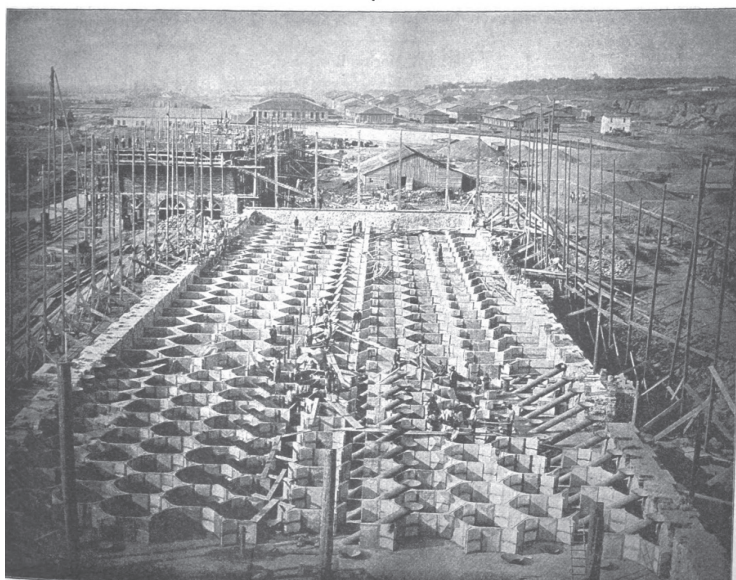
Etapă intermediară a construcției silozului de cereale de la Galați (imagine din anul 1887 ce prezintă montarea primelor elemente prefabricate de beton armat ale celulelor de depozitare) [1].
